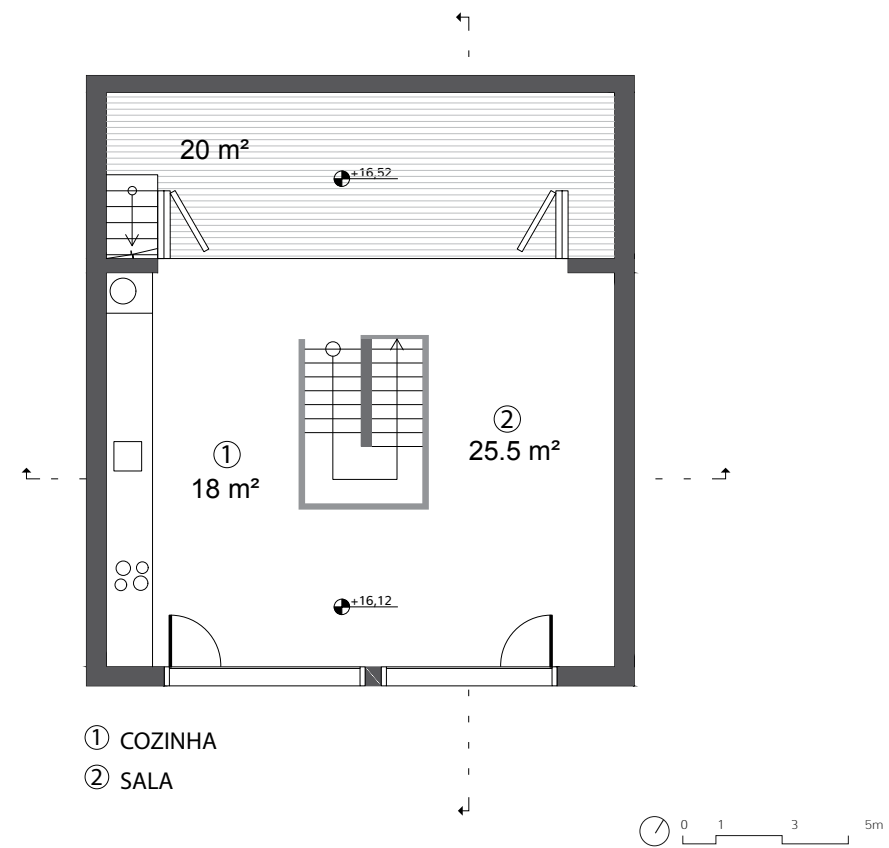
Planta baixa quarto pavimento - *Penthouse*.
